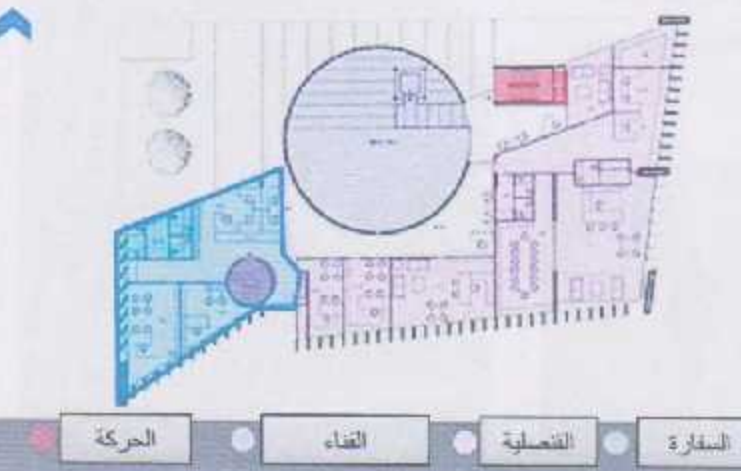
مسقط الطابق الأول - تفعيل من شبكة
